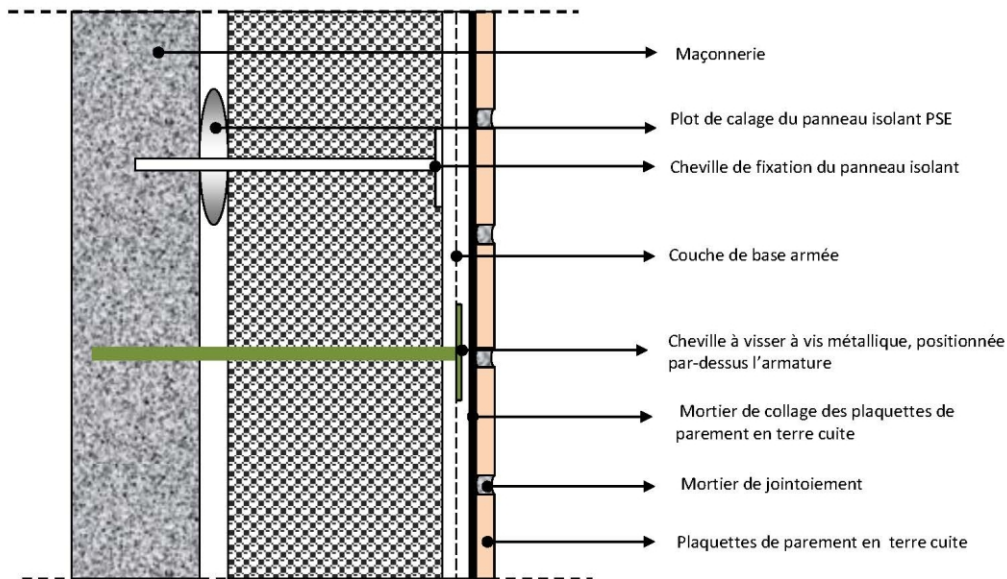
Principe du système avec finition plaquettes de parement en terre cuite (fixation du système ETICS selon le mode calé-chevillé)
